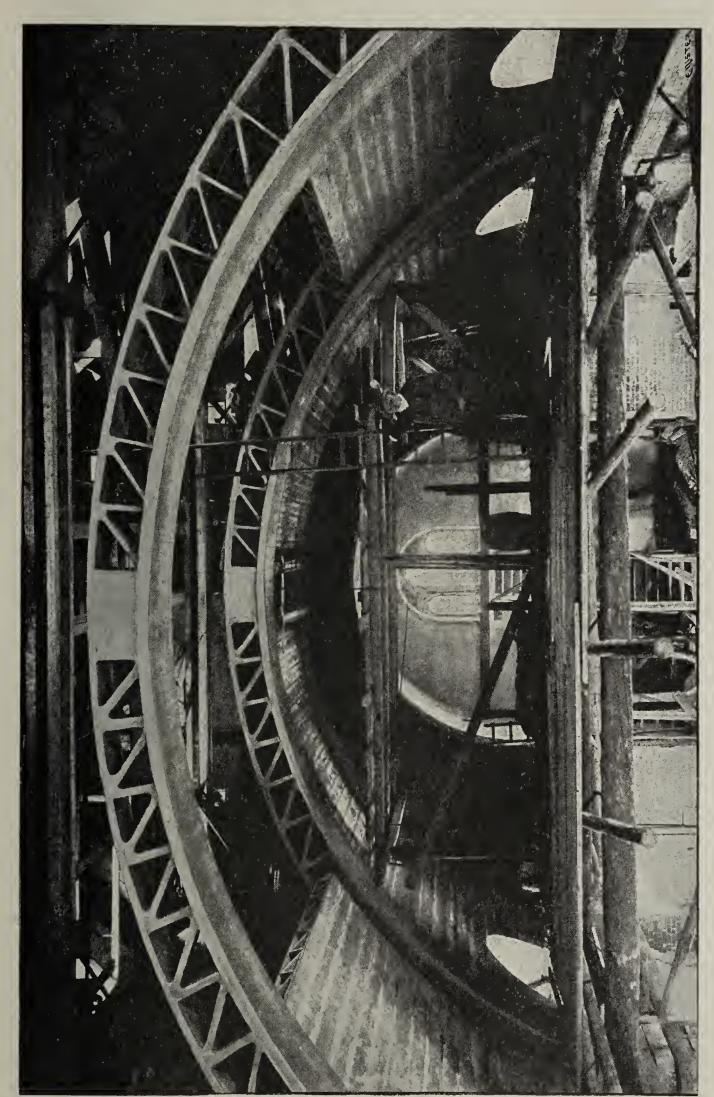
Decke der evangelischen Kirche in Außig a. b. E.
